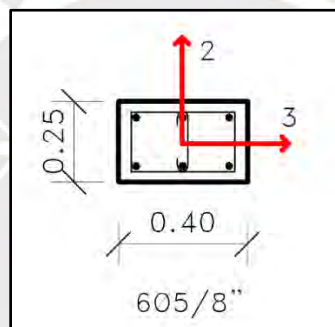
Direcciones locales y armado inicial de la columna central
